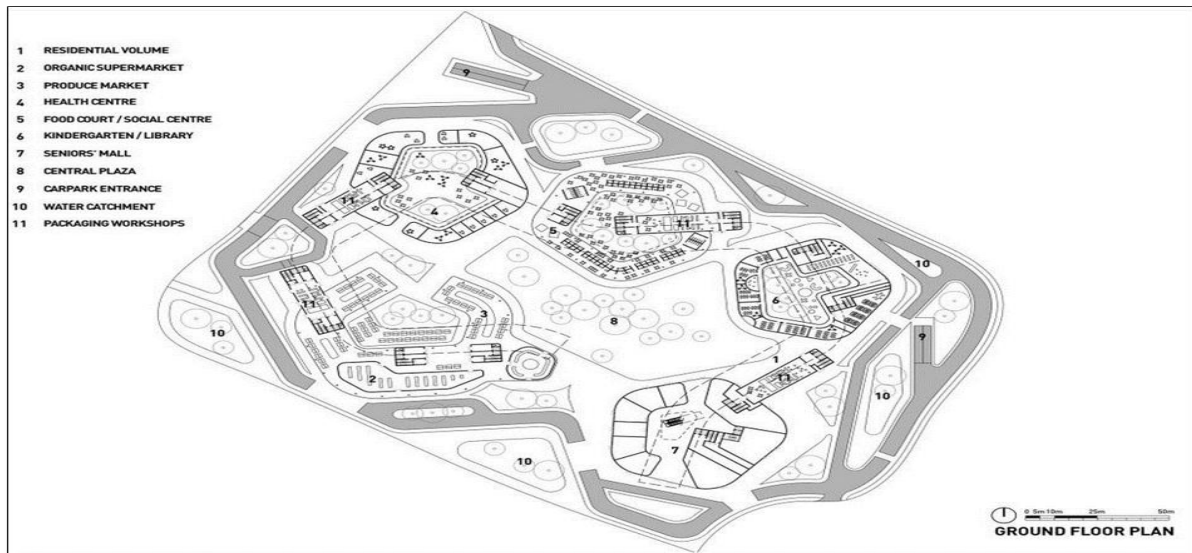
plan de Rez De Chaussée de La Home farm à Singapour
